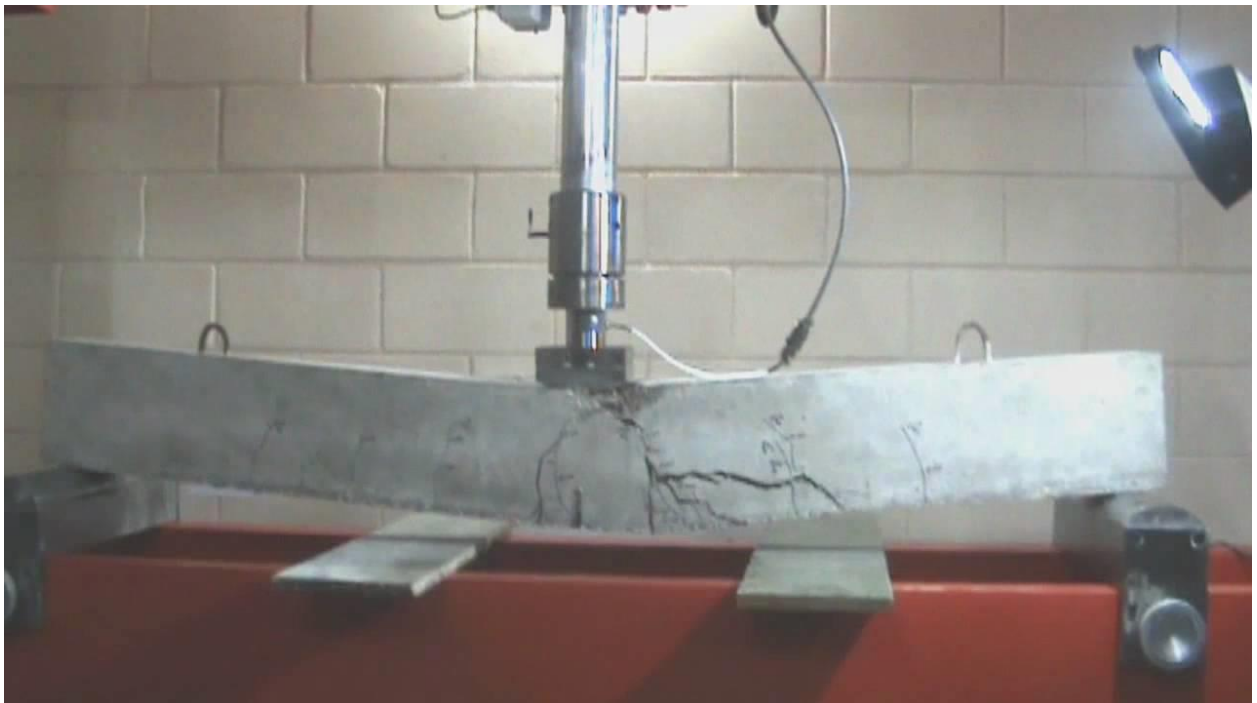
Falla por flexión en una viga de concreto reforzado. (Arteta, 2010).
